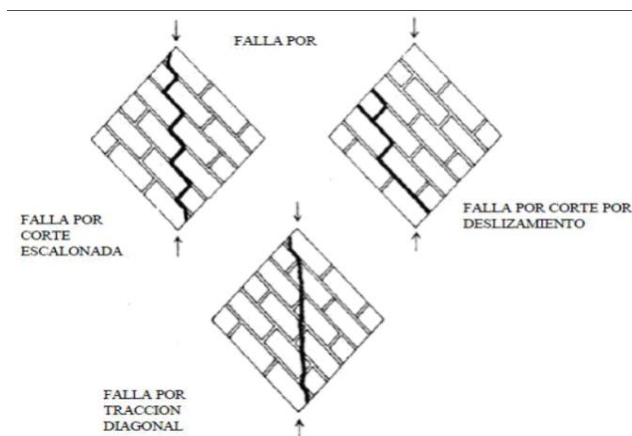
Tipos de fallas por ensayo a compresión diagonal de muro.
